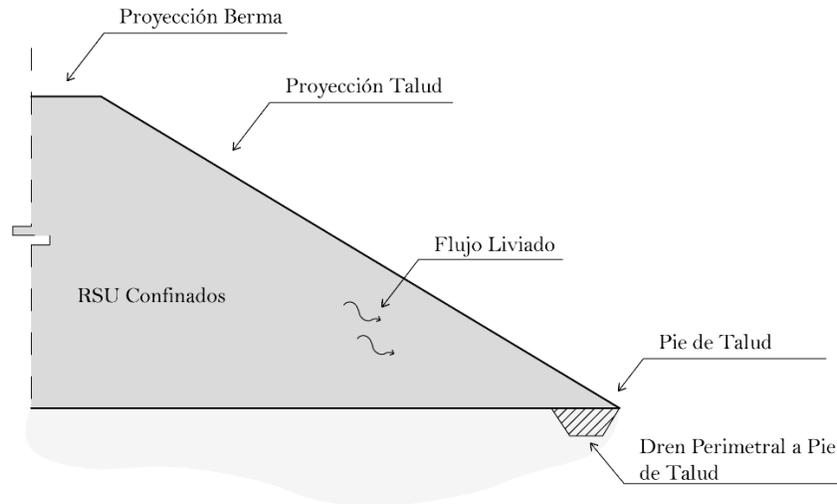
Diagrama de alternativa B de dren perimetral para la captación de lixiviado a pie de talud
